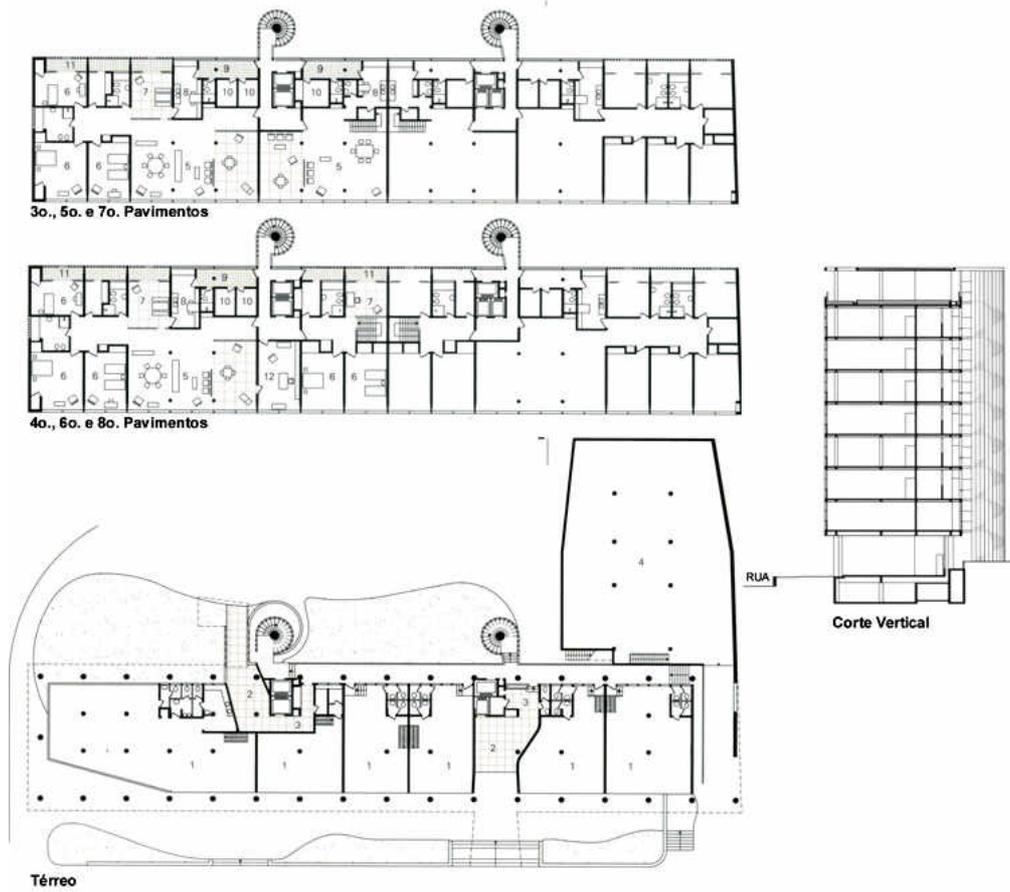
Edifício Nova Cintra – Plantas baixas do térreo e dos pavimentos-tipo e Corte Vertical (in Wisnik, 2001)
